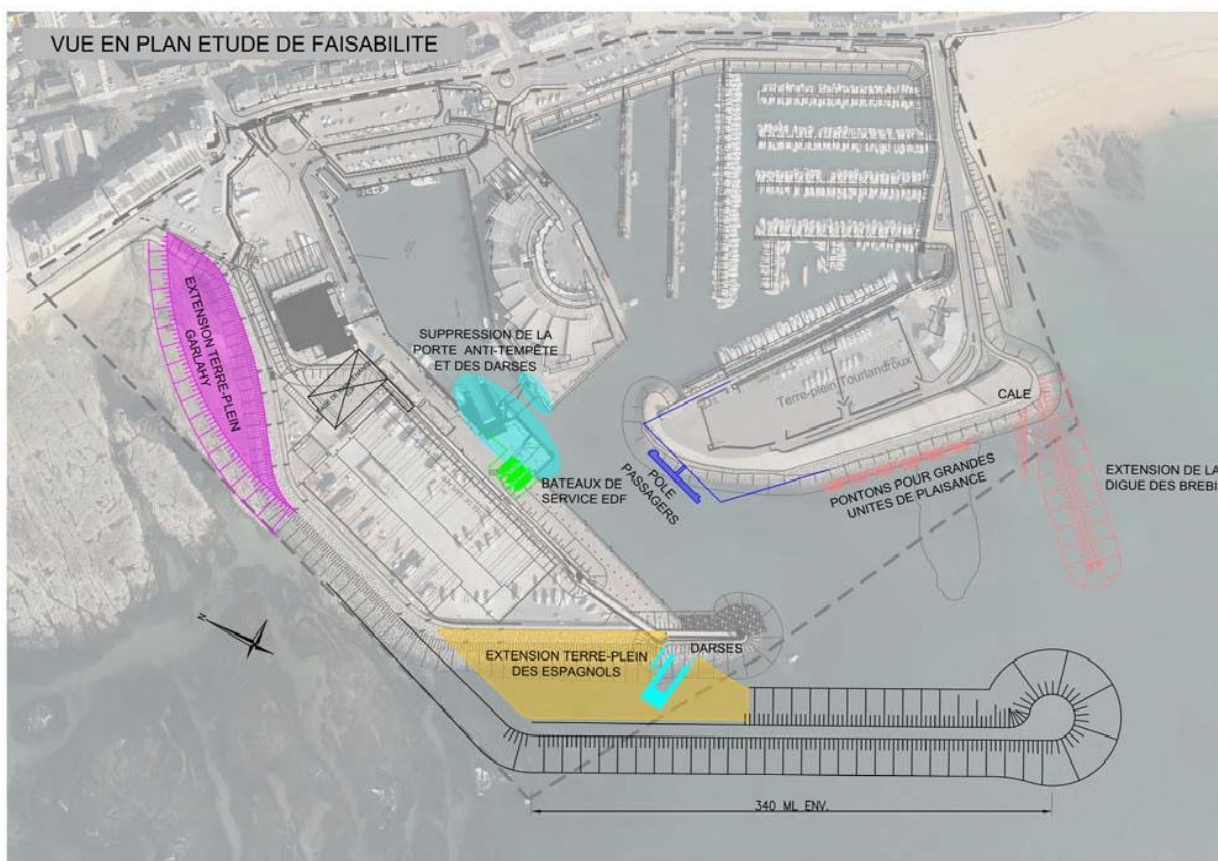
Le plan d'aménagement proposé pour les ateliers usages
